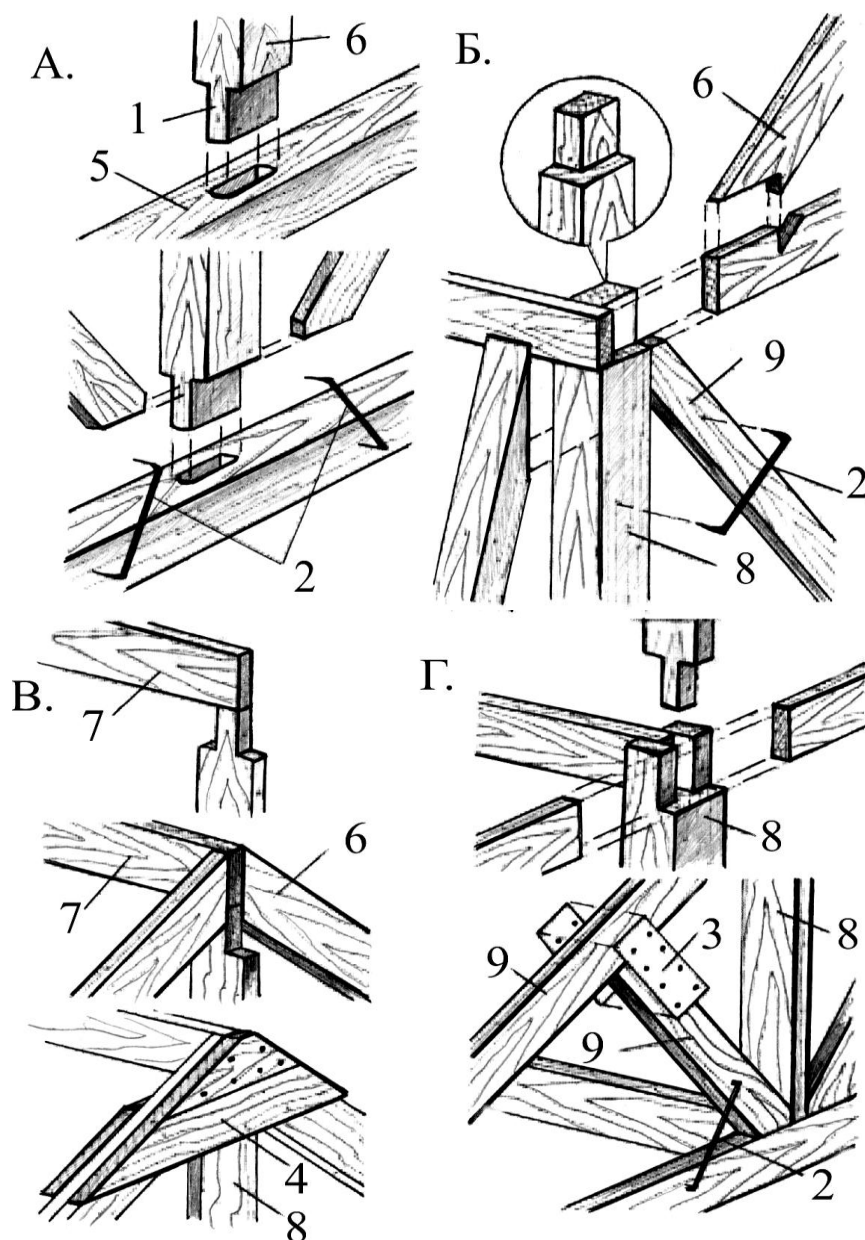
Узлы конструкций крыши с оптимальной площадью для мансарды:
